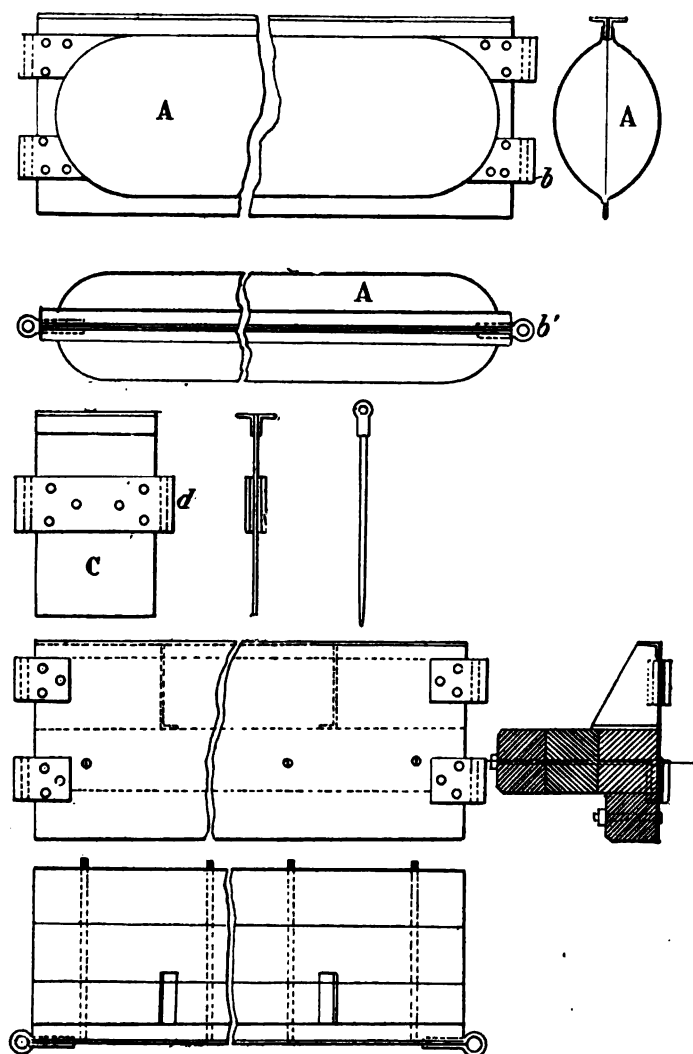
Élévation, profil, plan, détails, du barrage Raffart.
